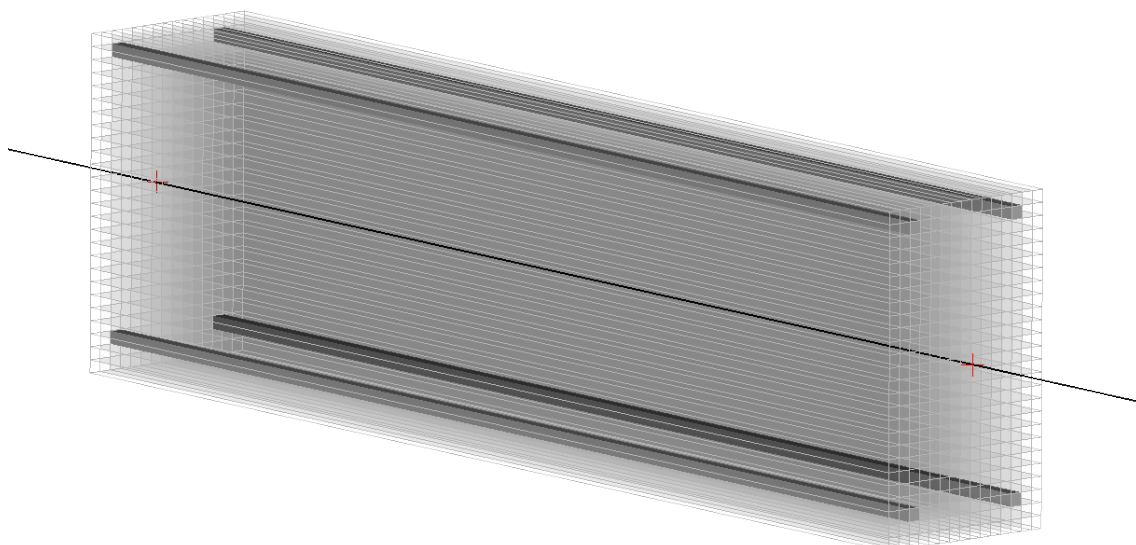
b : Modélisation d'une poutre béton armé par une poutre multifibre.
